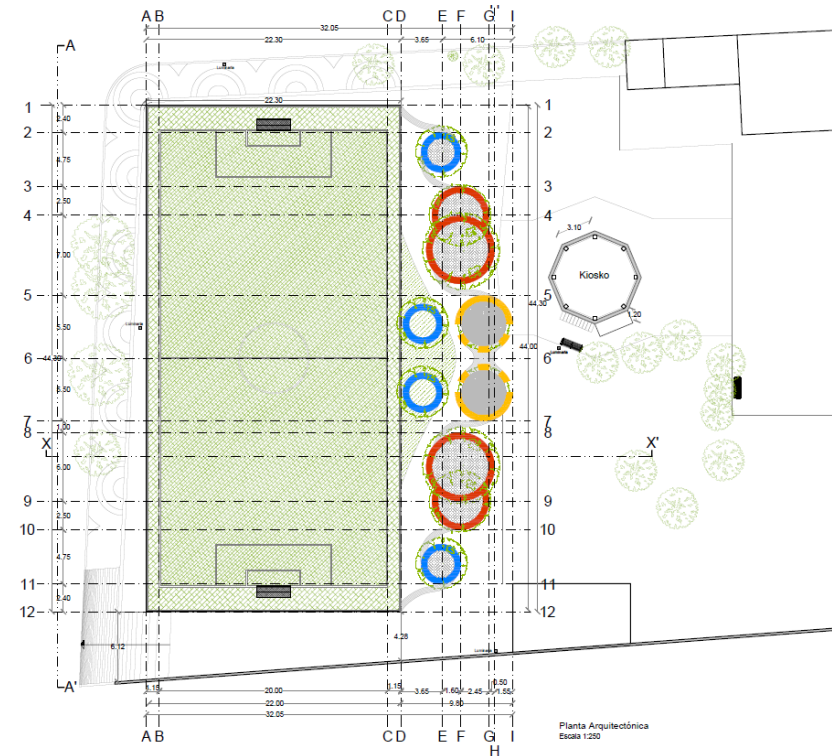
Planta arquitectónica de la propuesta final. (Autoría 2017).
